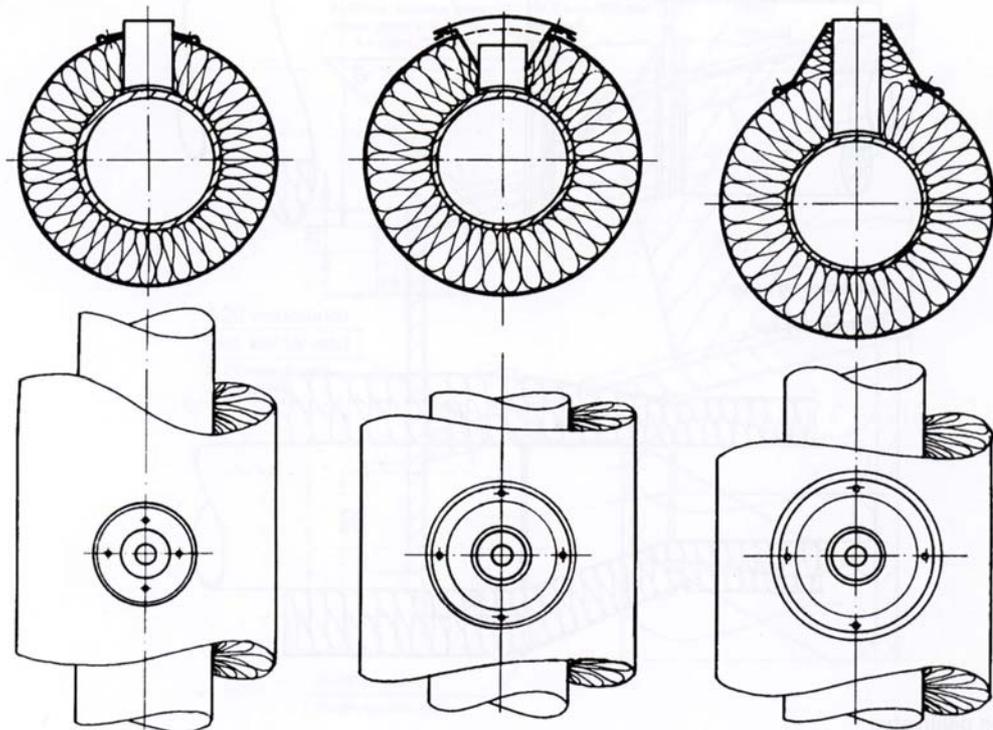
Участки трубопроводов с контрольно-измерительной арматурой
